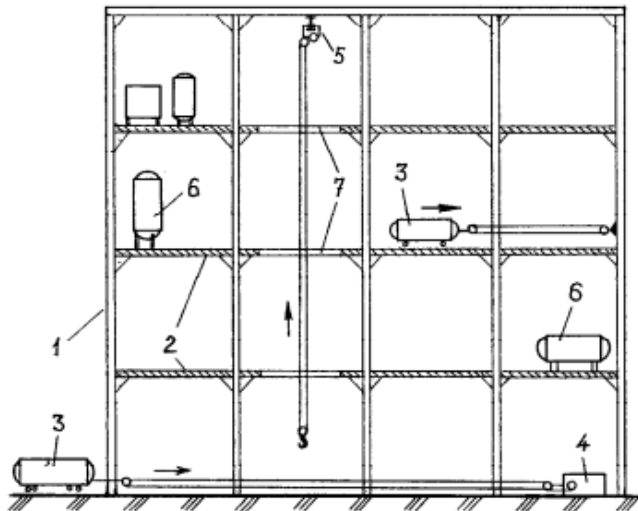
Монтаж обладнання у будівлях крізь монтажний проріз: 1 – каркас будівлі; 2 – міжповерхові перекриття; 3 – апарат, що монтують; 4 – підтягувальна лебідка; 5 – таля; 6 – змонтований апарат; 7 – монтажний проріз
